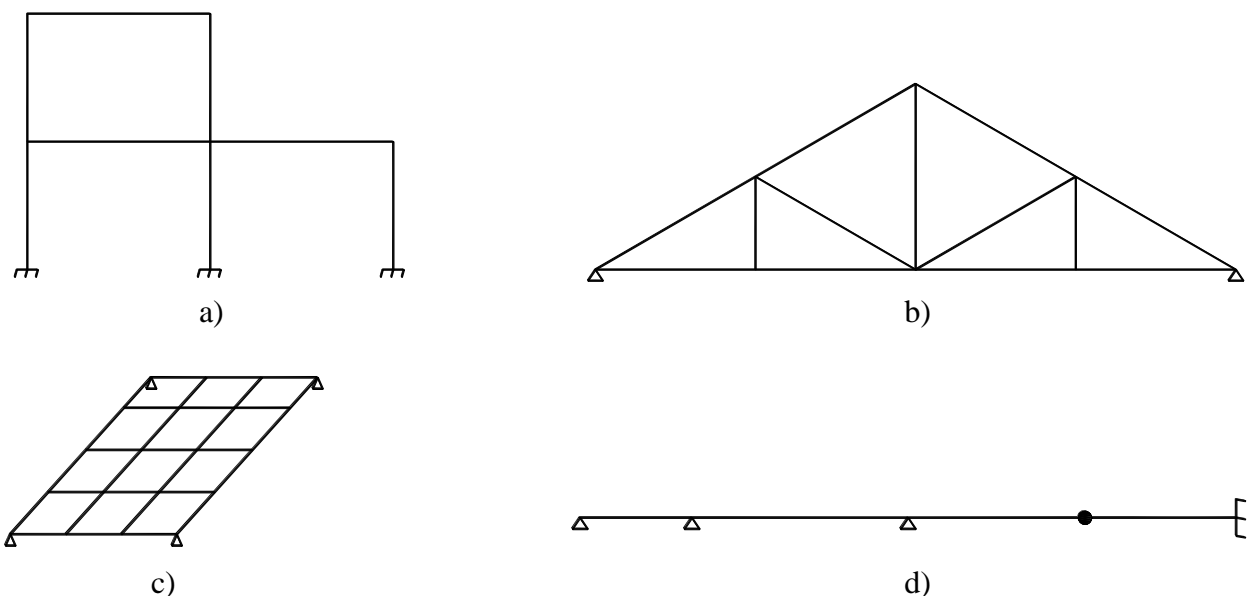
Estruturas reticuladas: a) pórtico; b) treliça; c) grelha; d) viga.
